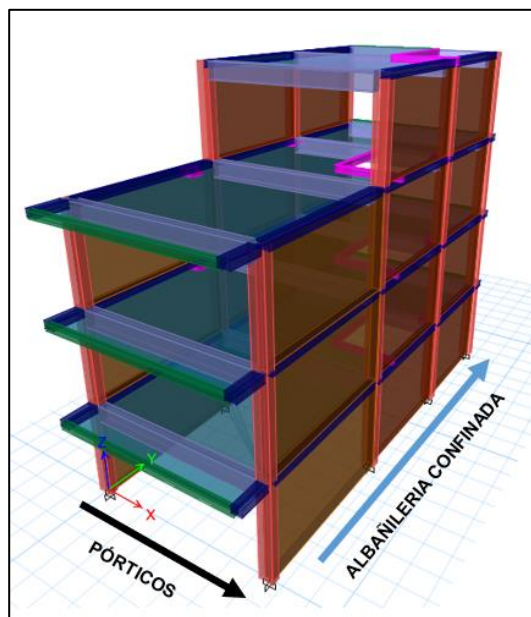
Sistema Estructural Mixto, Pórticos en la Dirección Transversal y Albañilería Confinada en la Dirección Longitudinal. Fuente: Elaboración propia.
